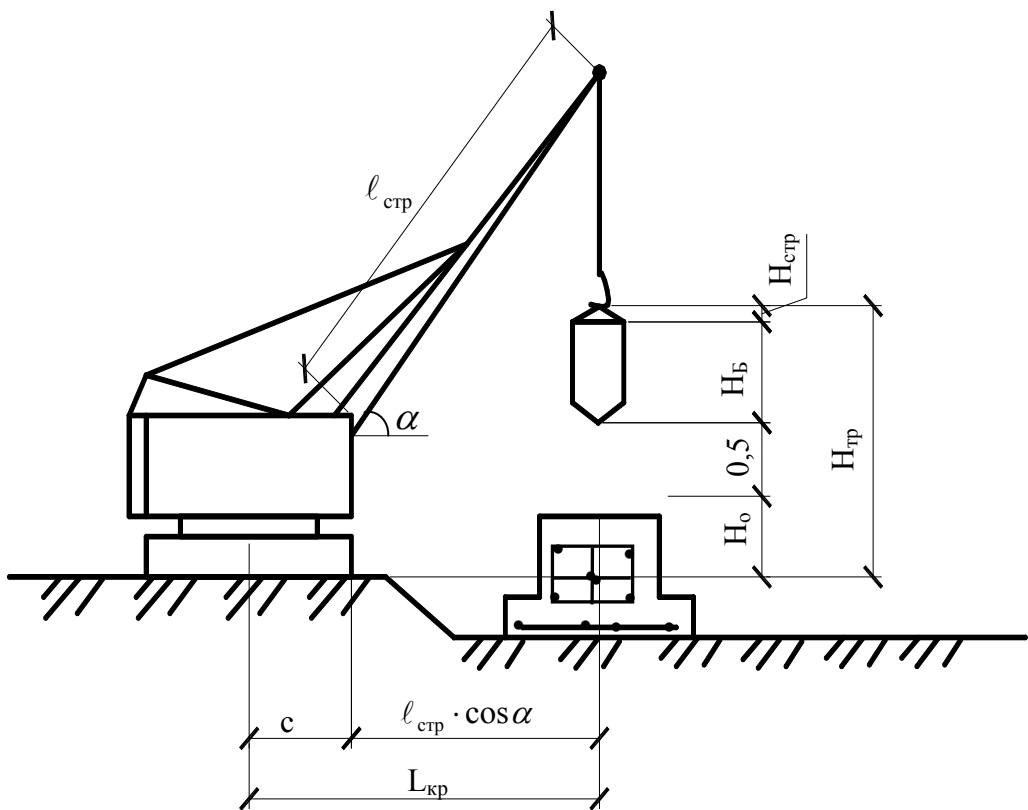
Определение требуемых параметров крана при бетонировании фундаментов.
